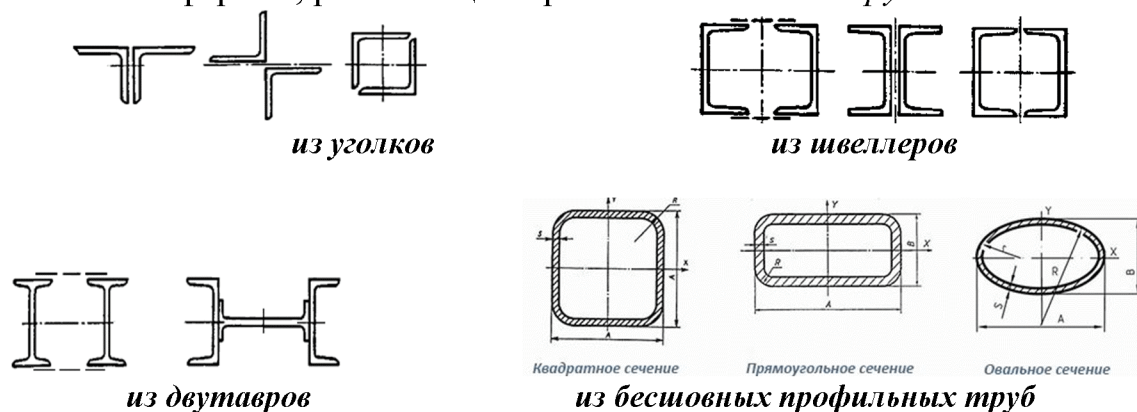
Сечения сварных ферм из прокатных профилей
